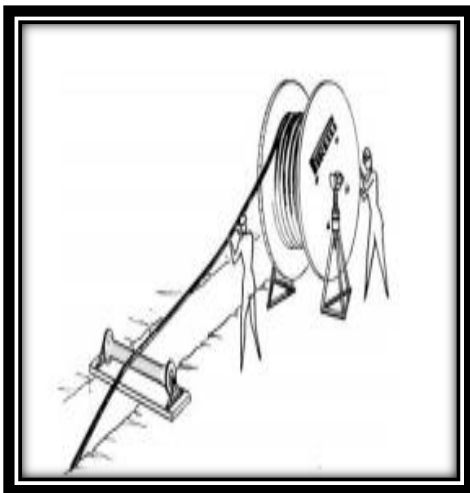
Metodo de poleas y rodillos. Figura 2.25.-Rodillo para cable.
